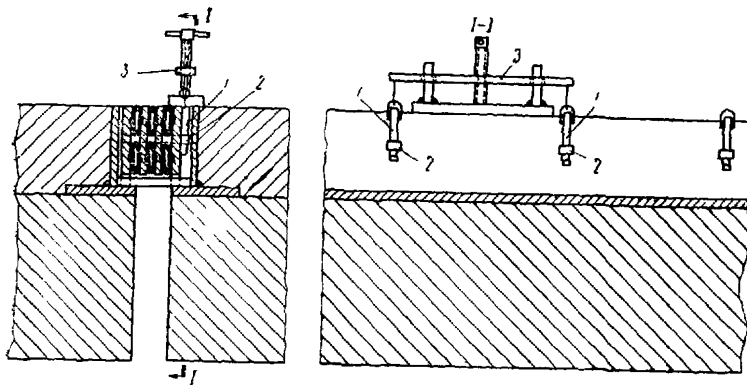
Приспособление для замены резино-металлических компенсаторов шва:
